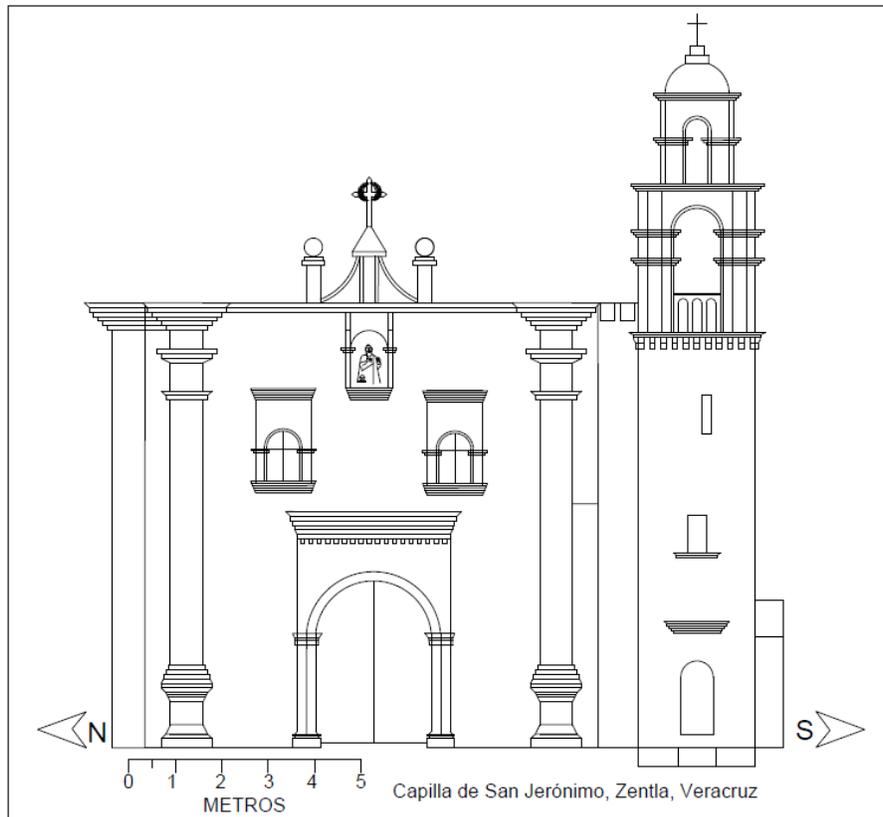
Alzado de la fachada de la capilla de San Jerónimo Zentla (levantamiento y plano de la autora).
